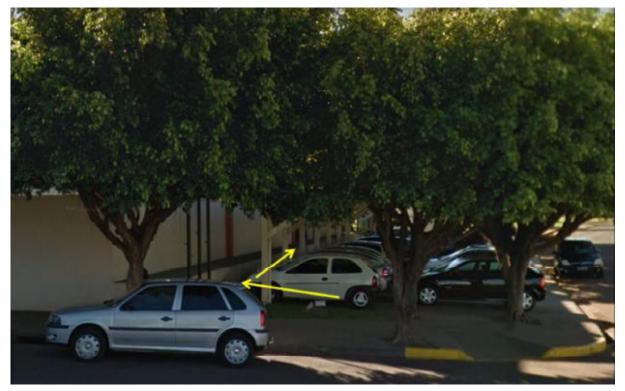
Indicação do local de construção da rampa de acessibilidade, na frente da edificação
